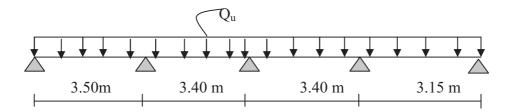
schéma statique d'une poutre sur plusieurs appuis
